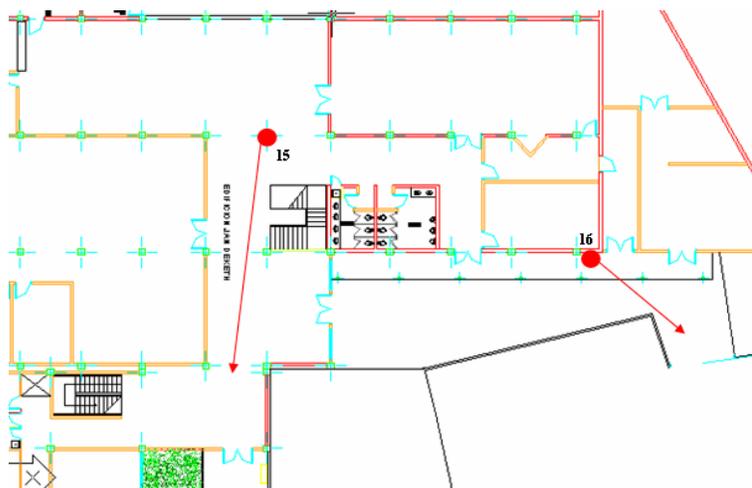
Ubicación de cámaras edificio Jan Deketh planta baja
